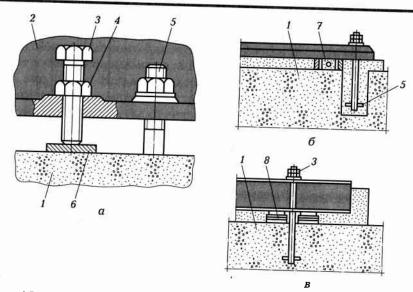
Способы выверки (выставления) оборудования на фундаментах:
